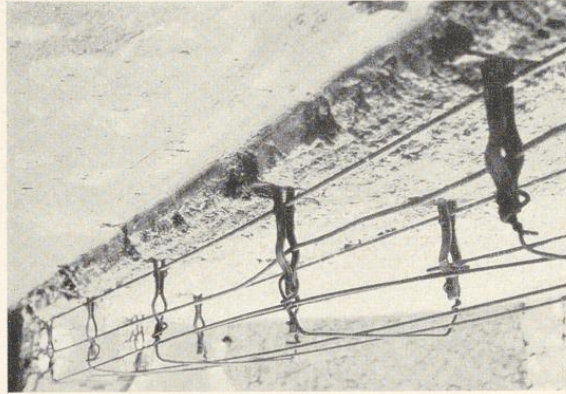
Abhängung der Rabitzkonstruktion an eiserner Trägerdecke mit angeschraubten eisernen Schellen
